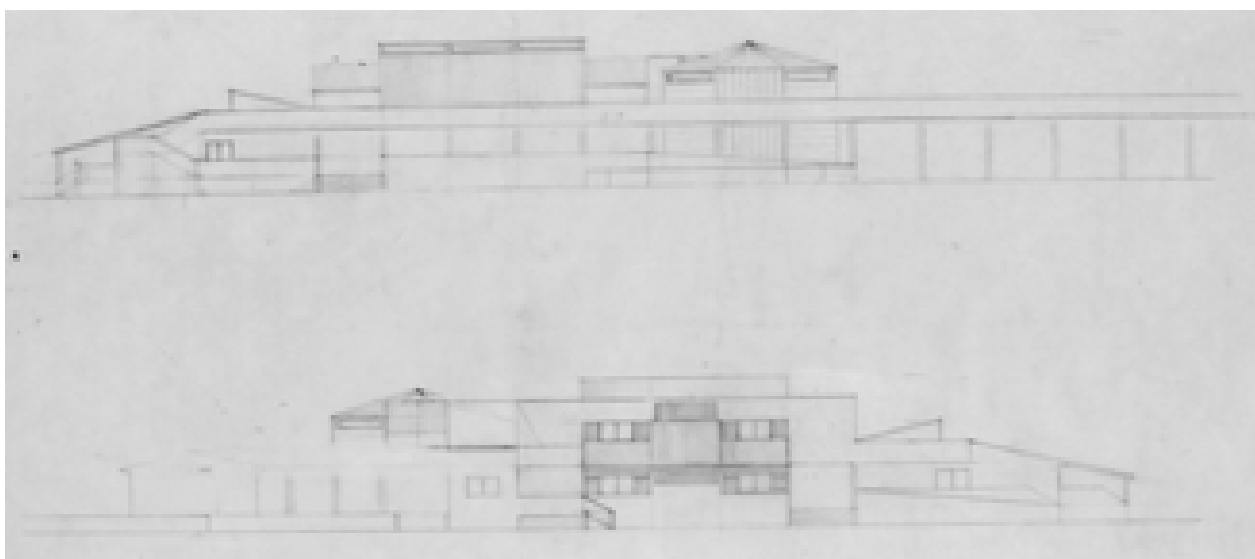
Prospetti Nord-Sud, stato futuro – 18/07/1989 (AABS-64_477)
